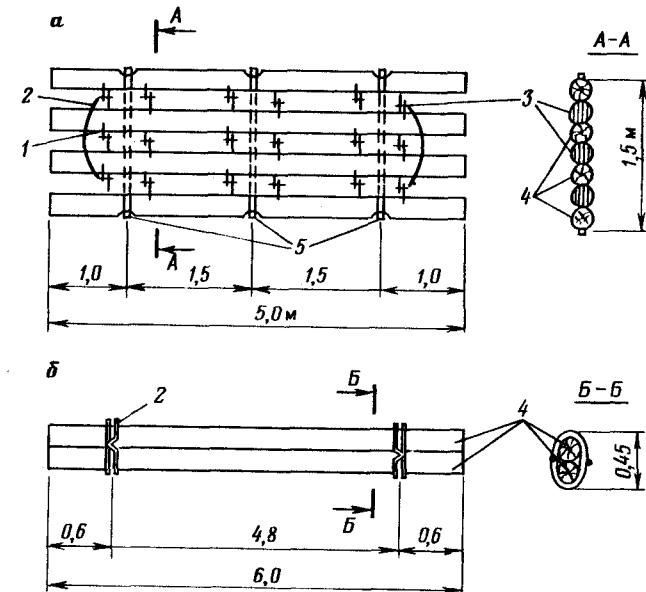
Конструкция перекидных сланей из лесоматериалов:
